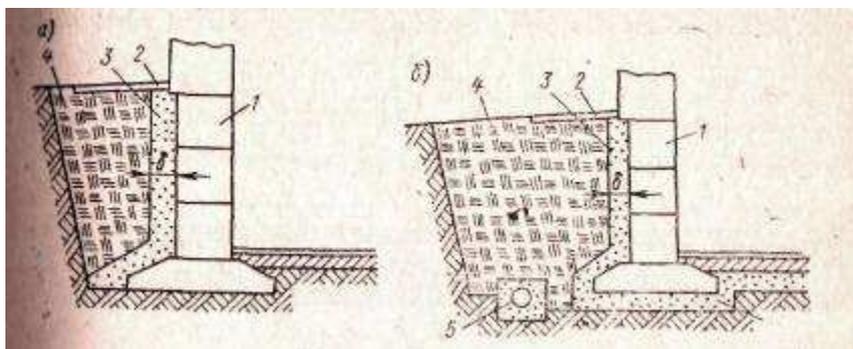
Засыпная гидроизоляция фундаментов (к п. 3.43)
